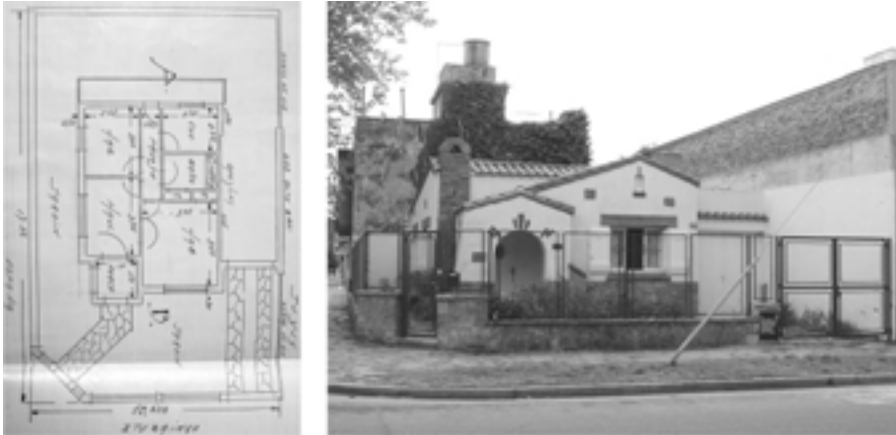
Chalet “estilo Mar del Plata” ubicado en el barrio La Perla (calle Ituzaingó 3499). Plano más antiguo (1939) y fachada en estado actual. Fuente: Plano del Archivo de Construcciones de la Municipalidad de General Pueyrredon y fotografía propia
